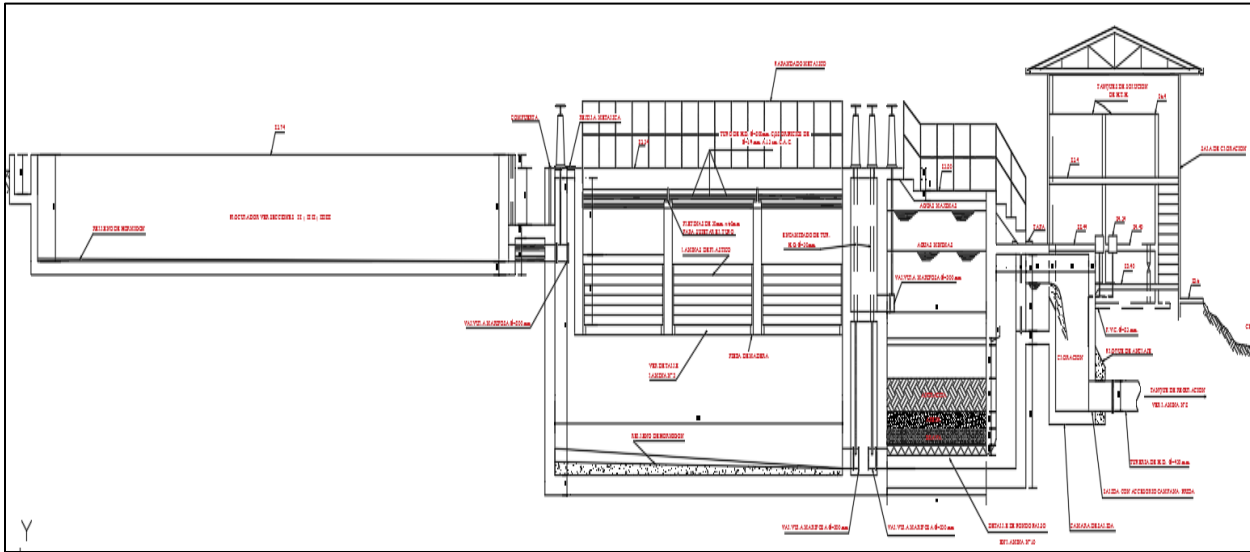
Corte longitudinal de la planta potabilizadora de Tabladita
